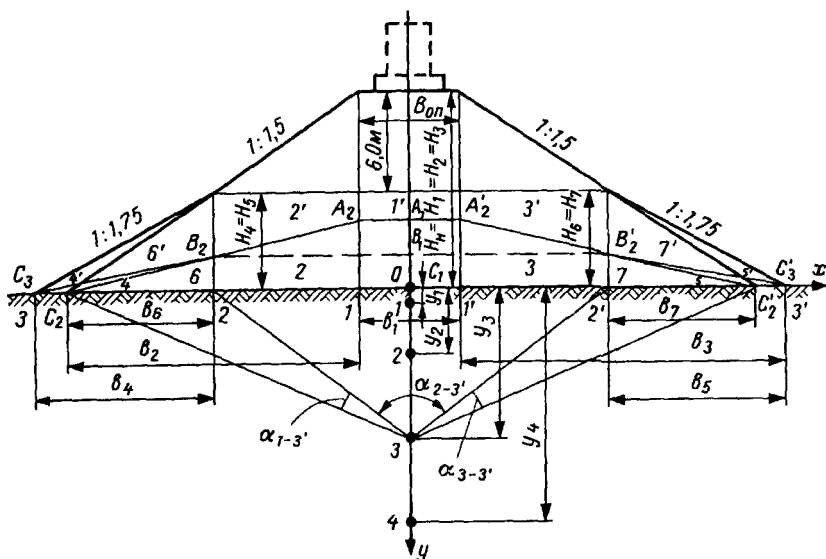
Расчетная схема для определения напряжений в основании насыпи.
